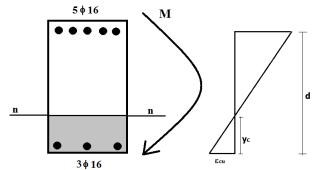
armatura e diagramma delle deformazioni nella sezione di verifica
